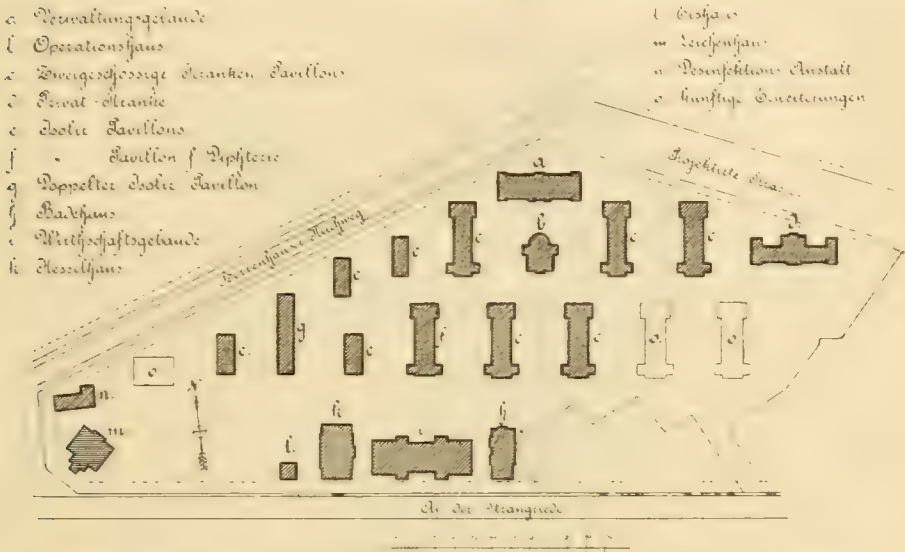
Neues Städtisches Krankenhaus an der Strangriede zu Hannover. Lageplan.
